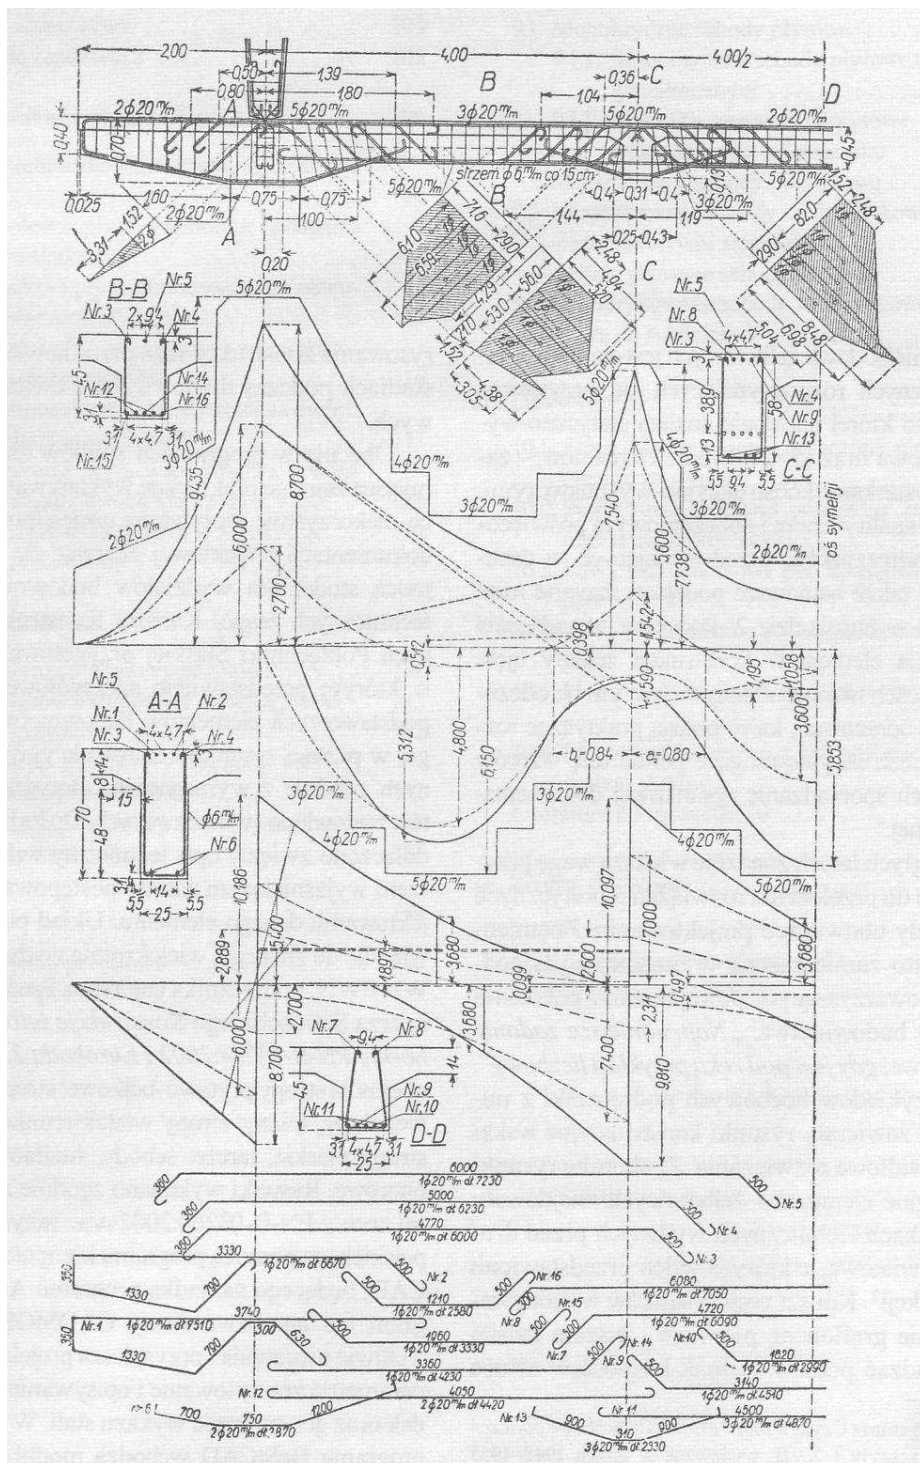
Przykłady zbrojenia konstrukcji żelbetowych według Hallera [24]
